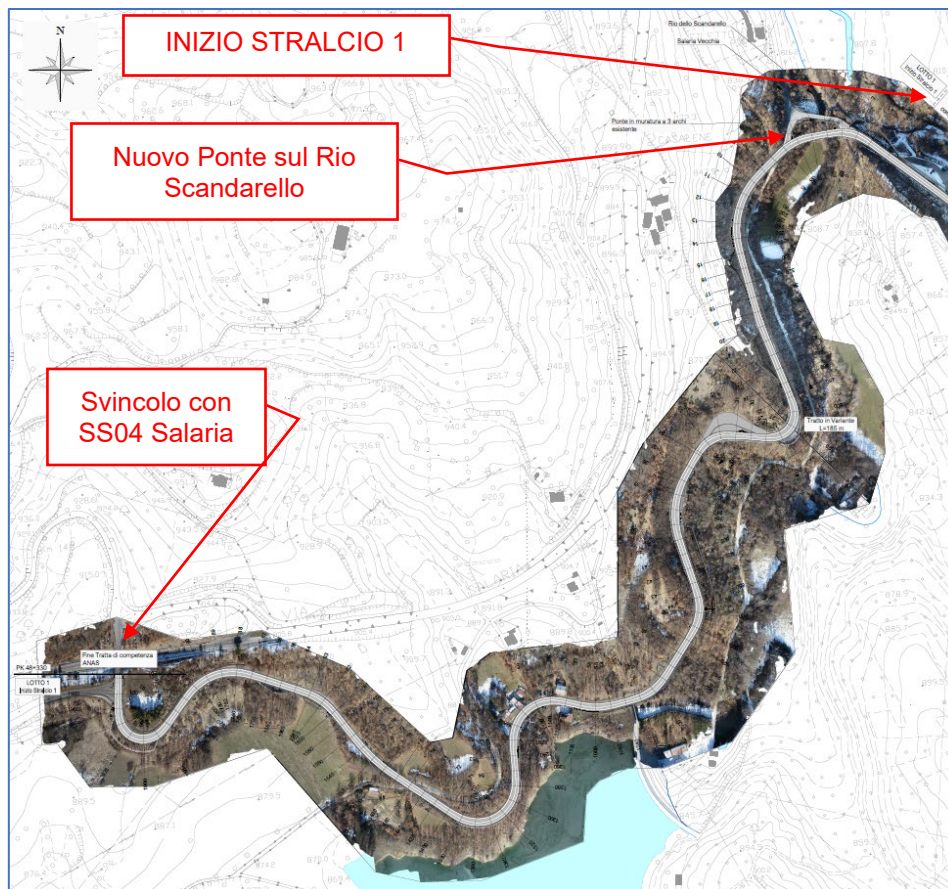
b – Stralcio 1 – Planimetria generale di progetto
